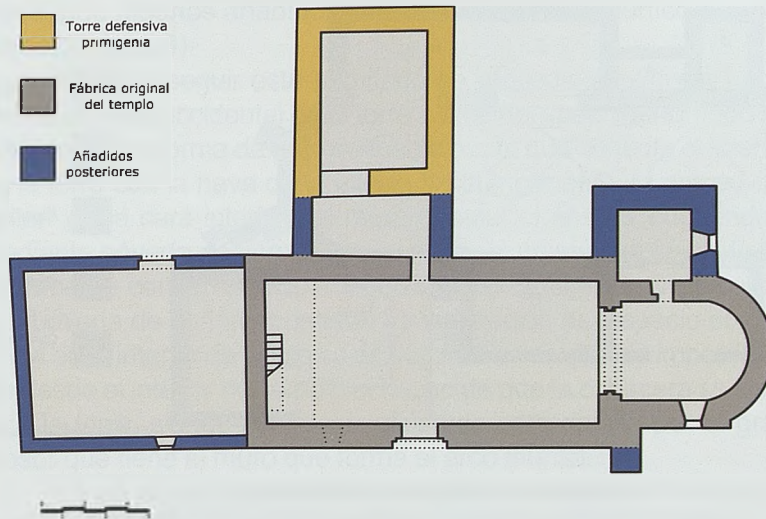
Planta del estado actual de la iglesia de Aldealpozo, con sus fases constructivas
